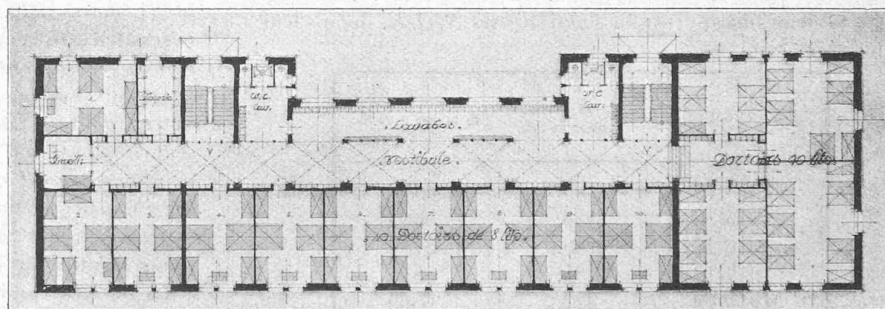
Plan du 1^{er} étage. — 1 : 500.
